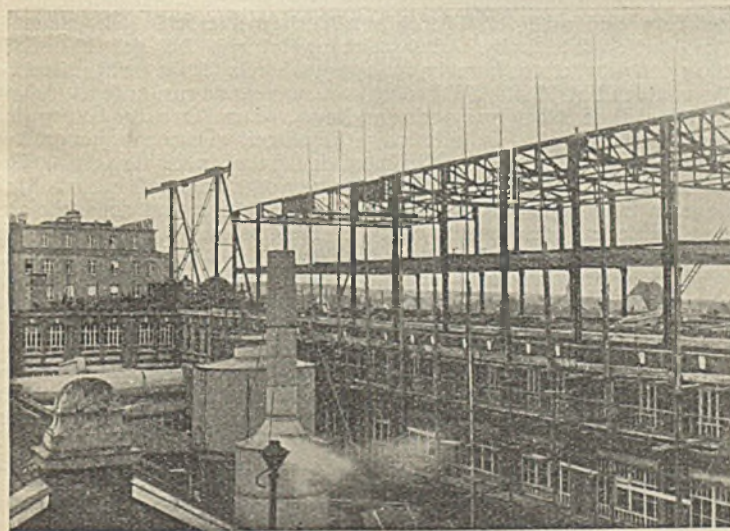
Aufstellung der Dach- und Stützenkonstruktion.
